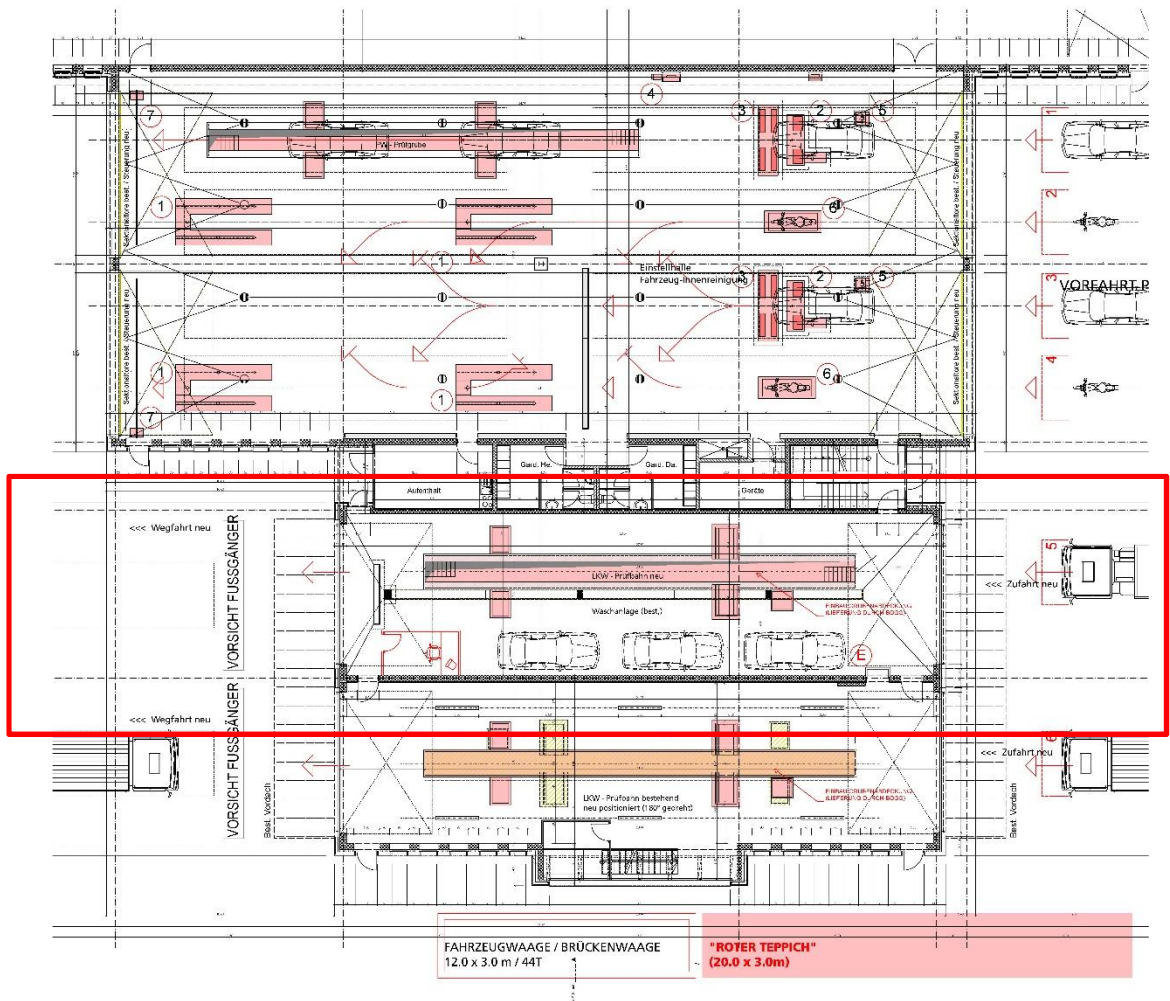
Grundrisslayout Prüfhalle 2, Erdgeschoss
